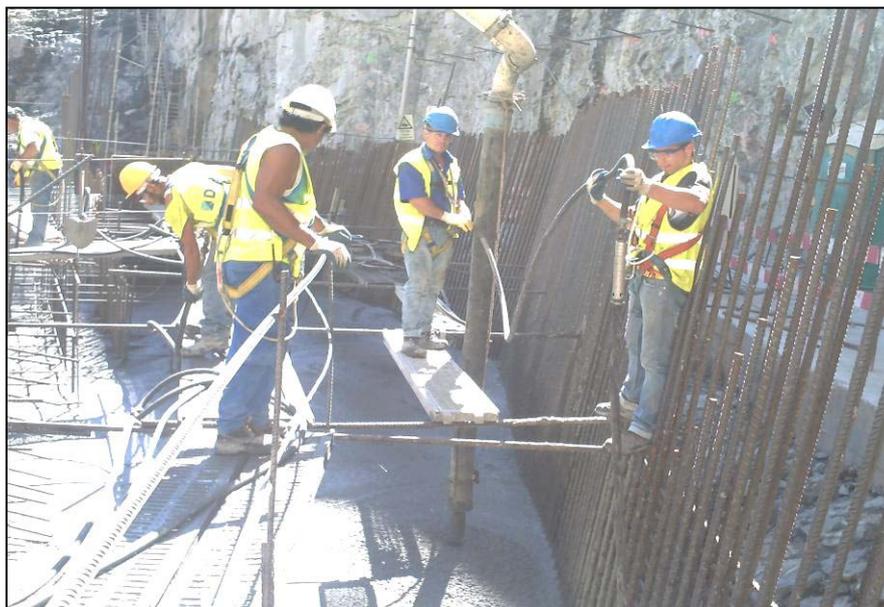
Central. Grupo 2. Retoma da betonagem
